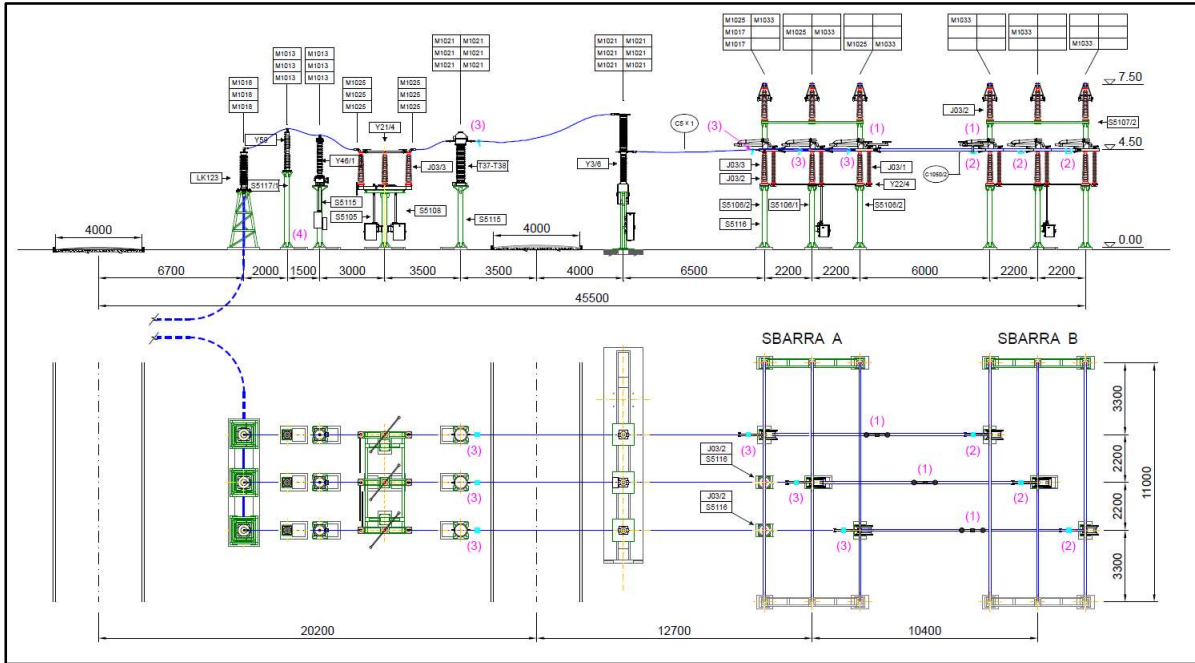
Planimetria e sezione elettromeccanica relativa alle apparecchiature dello stallo 150 kV nella stazione Terna
